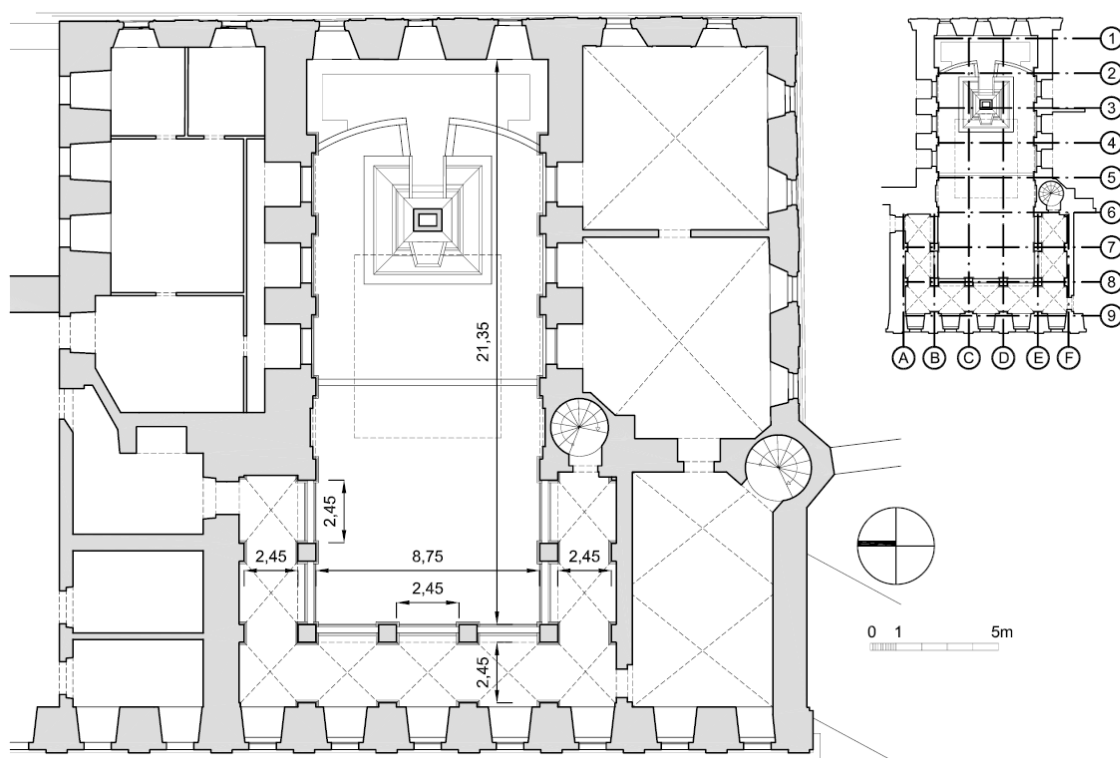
Rekonstruktion, Grundriss 2.Obergeschoss, in Anlehnung an [Sch 04/1]
